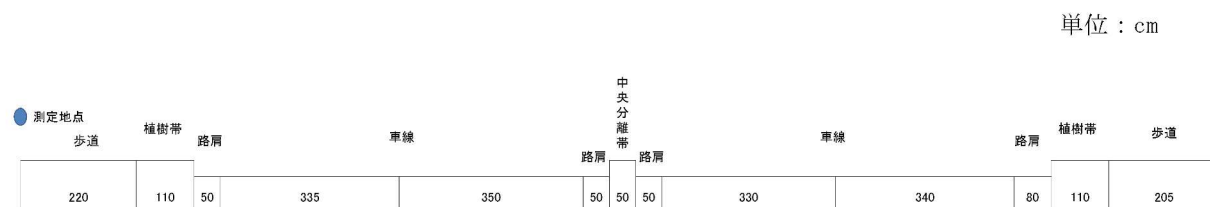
地点7（曙小学校前）の道路構造断面図
